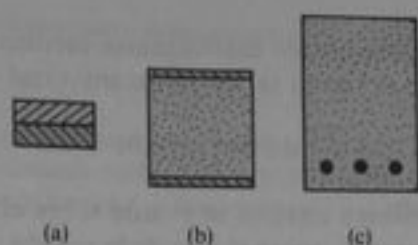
Secciones transversales de vigas compuestas: (a) viga bimetalica, (b) viga tipo emparedado y (c) viga de concreto reforzado
